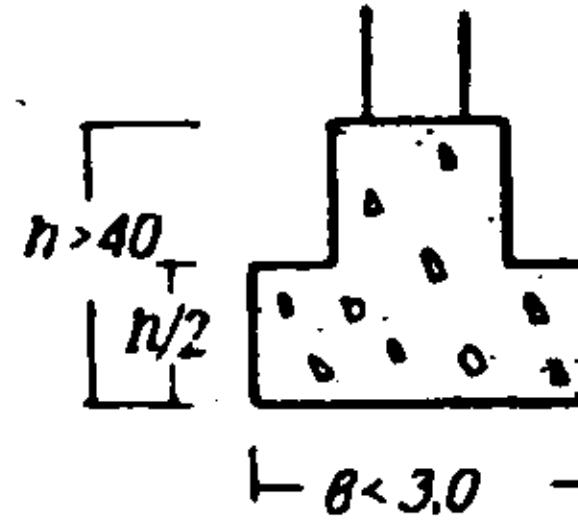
Расширение ленты осадочного шва с парными колоннами
